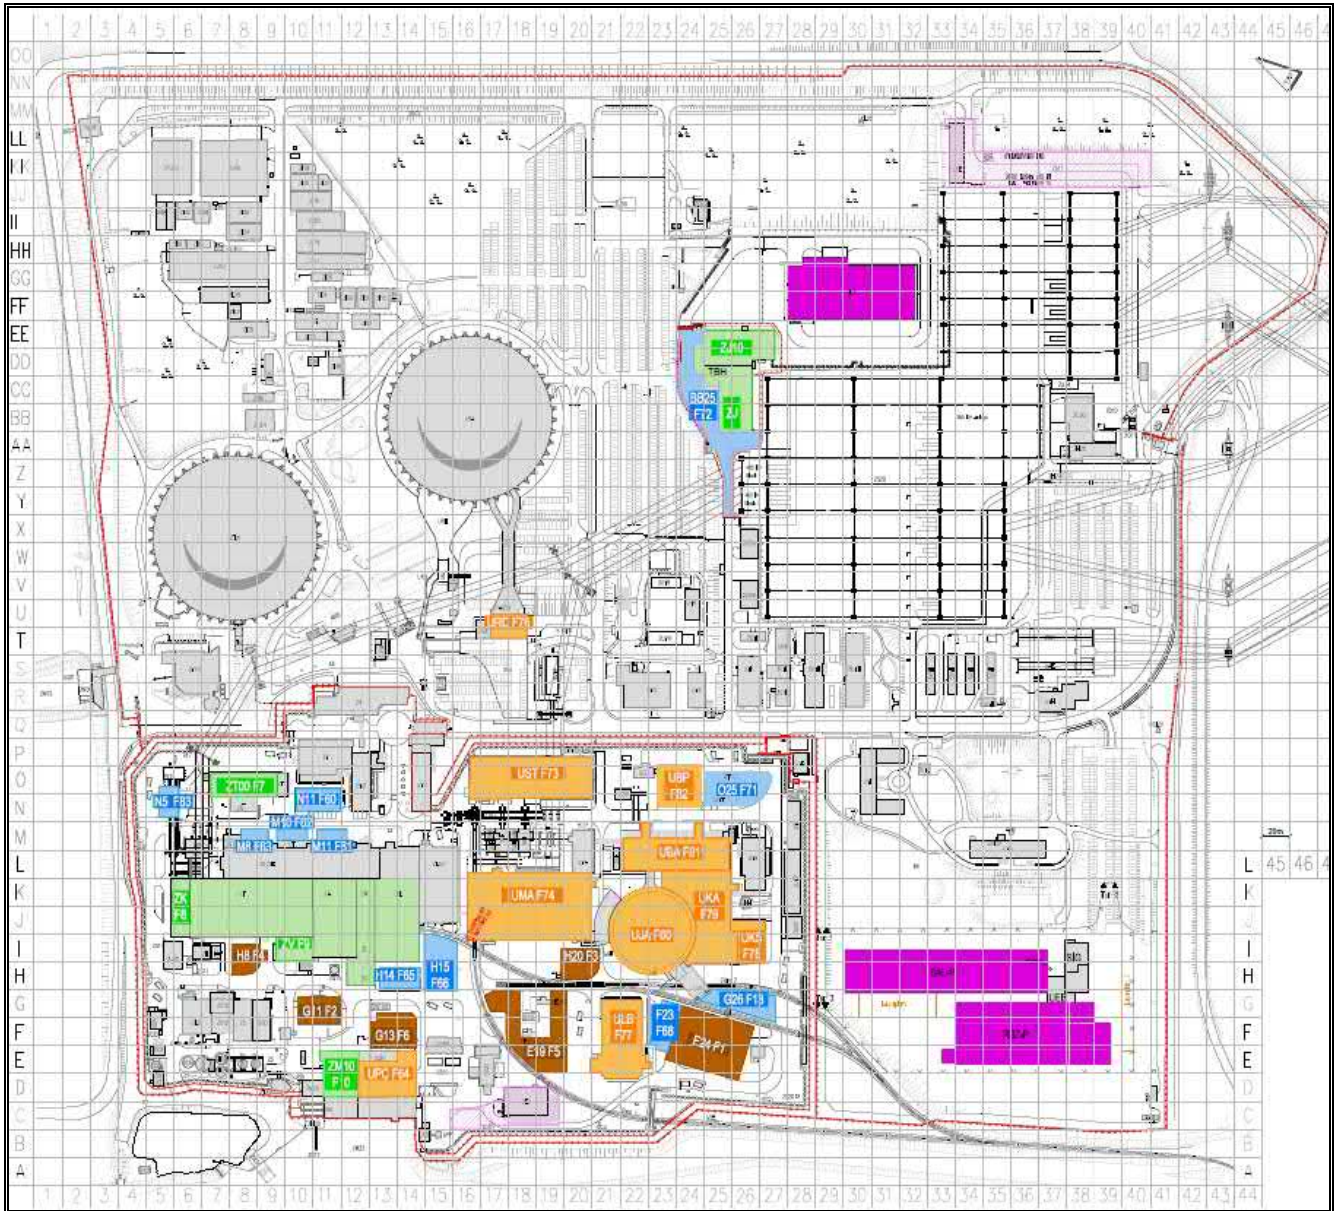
Lage der betrachteten Lagerflächen des Vorhabens SAG KKP 2 (blaue Flächen) (EnKK Lager- und Pufferflächenplan 2016)
